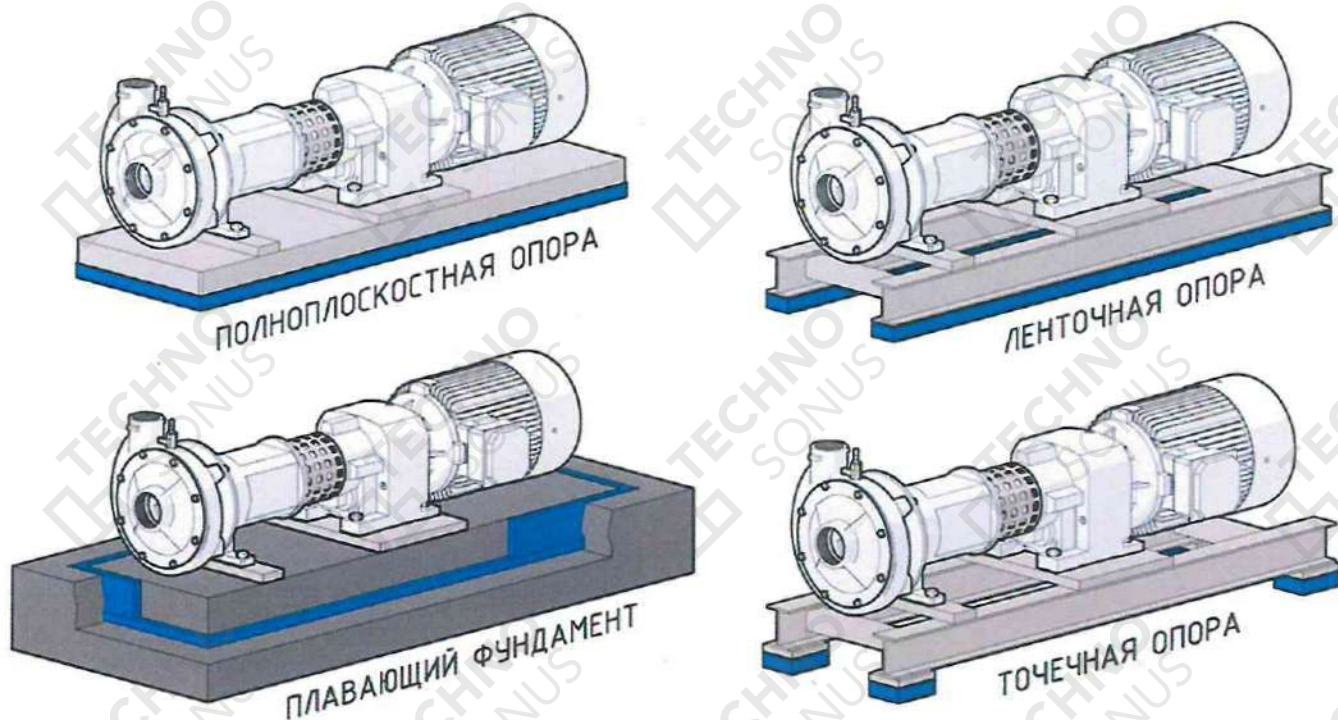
Типы раскладки систем виброизоляции под технологическое оборудование (полноплощадная раскладка – тип В, ленточная раскладка – тип А, плавающий фундамент – типы А.1, В.1, С.1, точечная раскладка – тип С)
